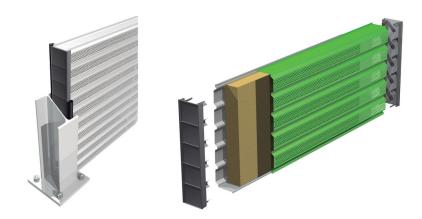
Detalles de pantallas acústicas metálicas con tapas laterales.
